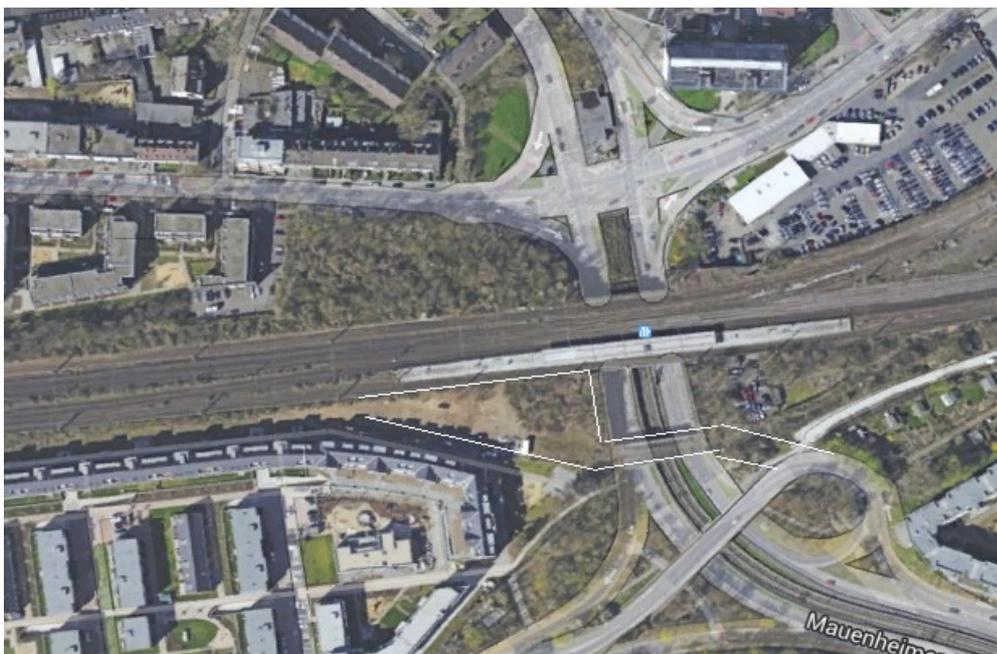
Luftbild Baustellenzufahrt über Bahnbrücke und Lagerfläche.
